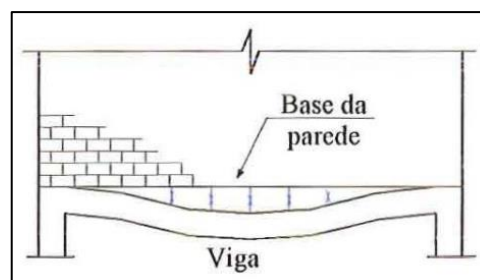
Edificação em alvenaria estrutural sobre pilotis em concreto armado.
